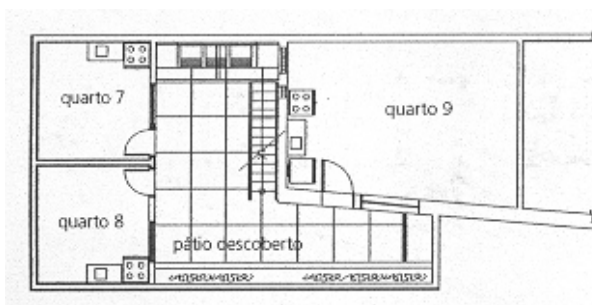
Cortiço na Travessa do Mosqueira, 20 – Planta baixa do subsolo (SECRETARIA, 2000, p. 40).
